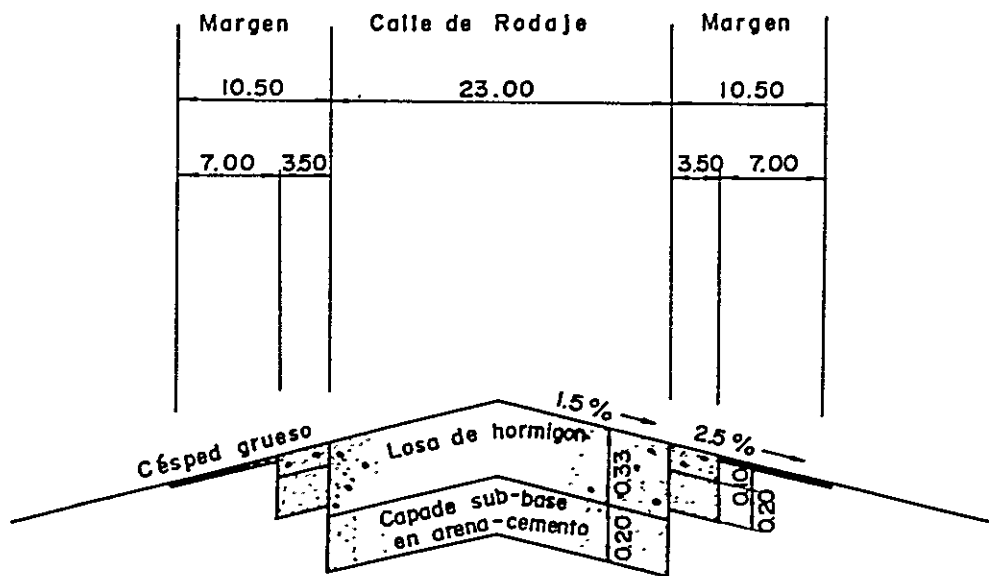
Sección Típica de Pavimento Rígido - Calle de Rodaje
